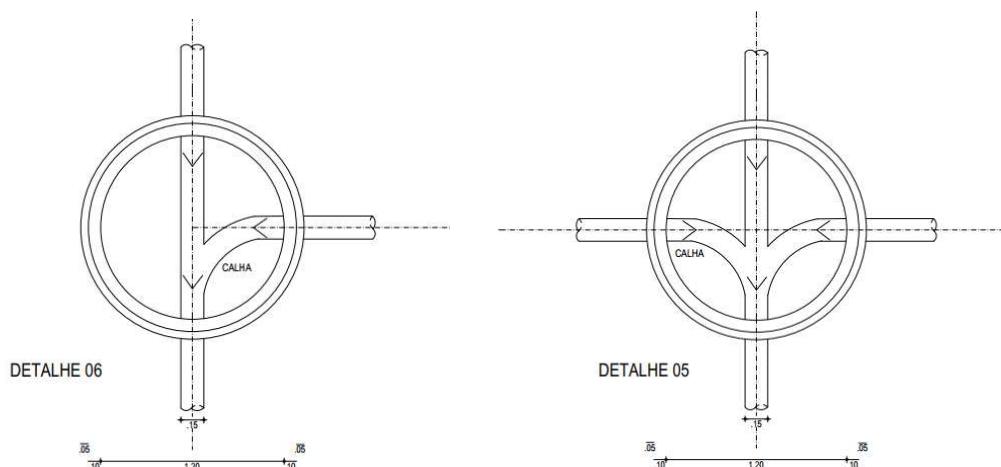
Poço de visita redondos em anéis pré-moldado de concreto
